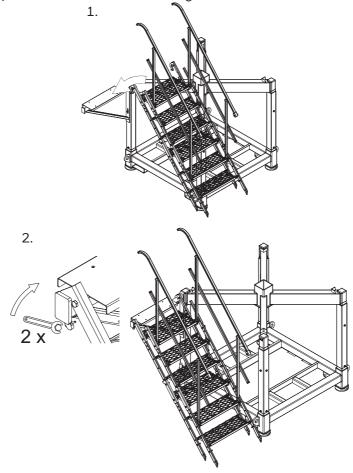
Montare la scala laterale sulla staffa 8890. Controllare la scala di cantiere UI prima dell'installazione
